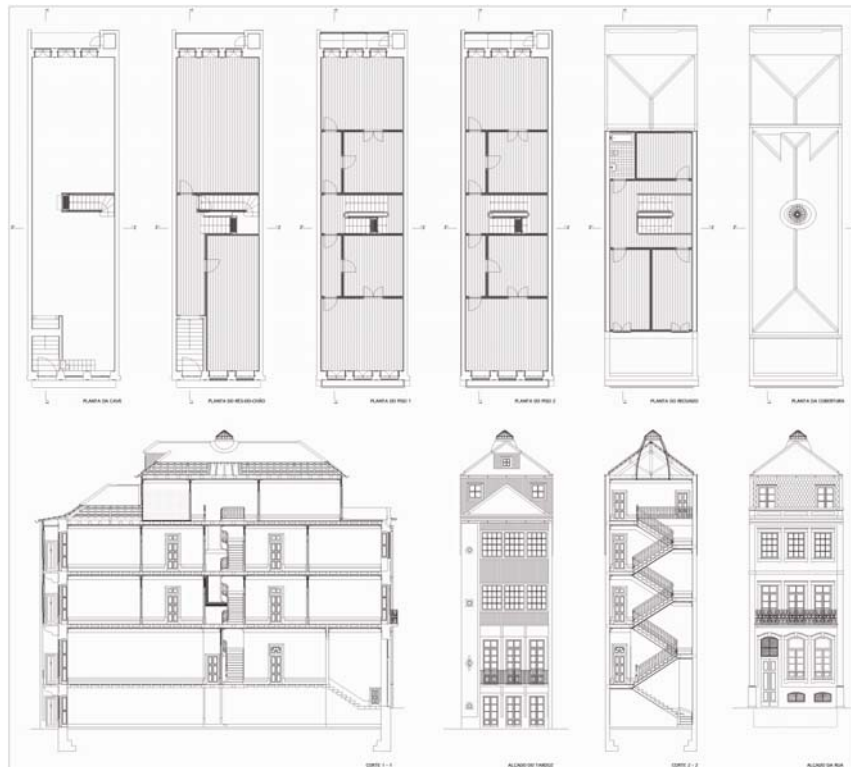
Modelo construtivo da casa burguesa do Porto. Plantas, cortes e alçados.
